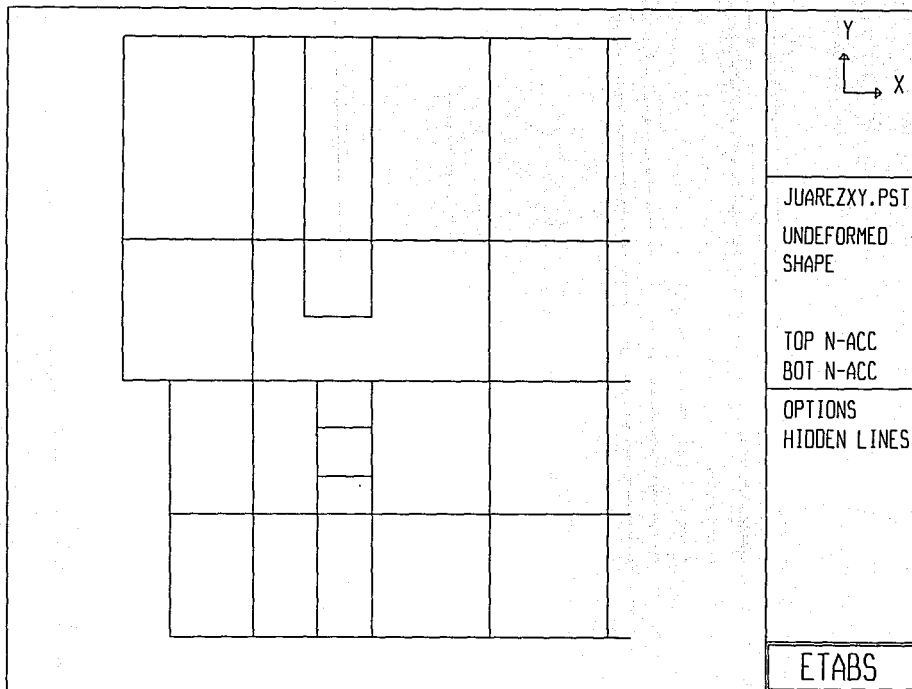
g VISTA EN PLANTA DEL NIVEL DE ACCESO PARA ETABS
